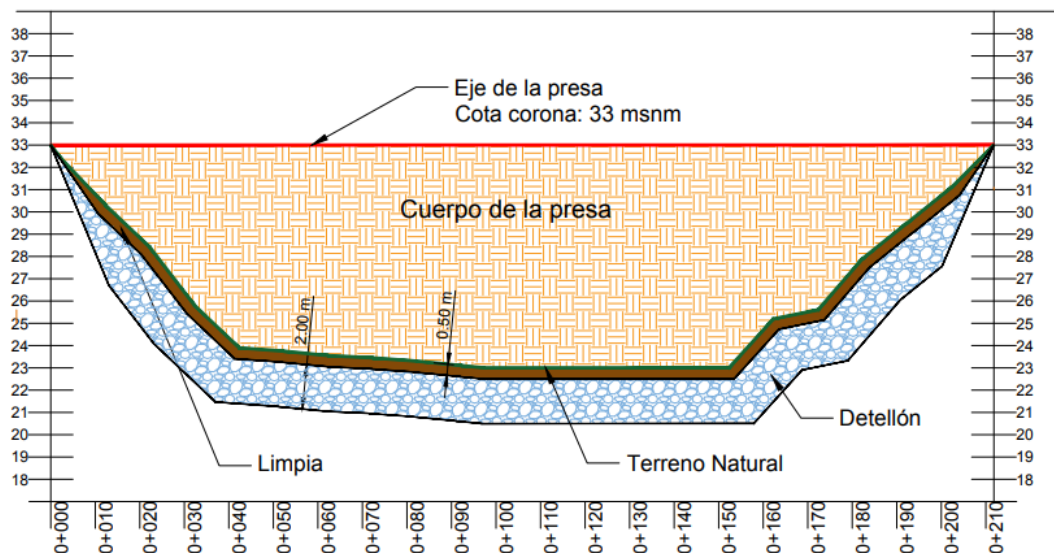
Perfil longitudinal del Detellón, [Elaboración propia, 2021]
